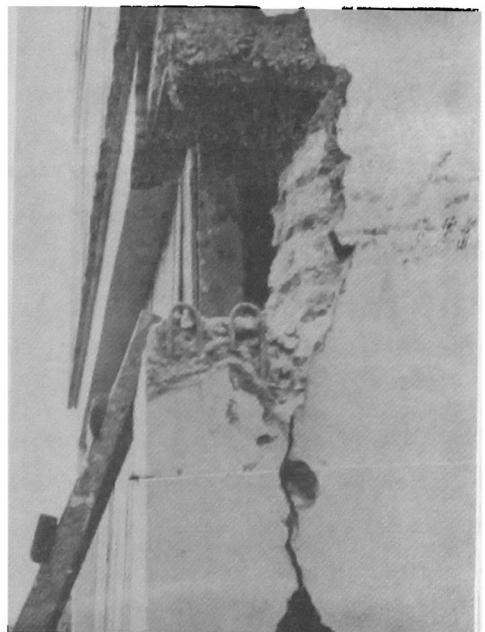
Detalle de Fig. 37, después de picar el hormigón. La armadura del pilar no llegaba a la cadena.
